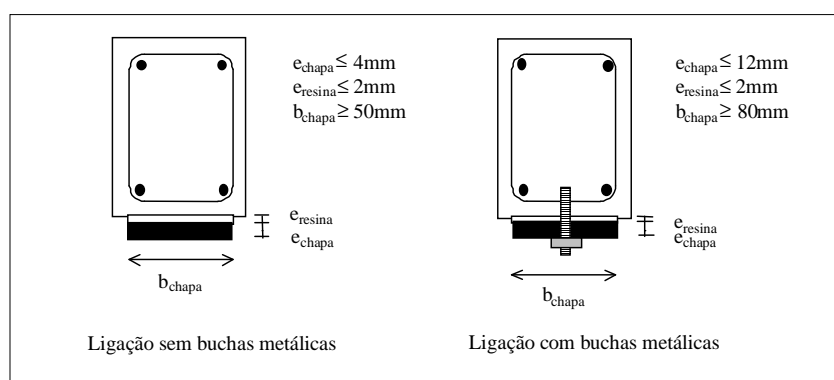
Reforço de vigas à flexão com chapas metálicas [31].
